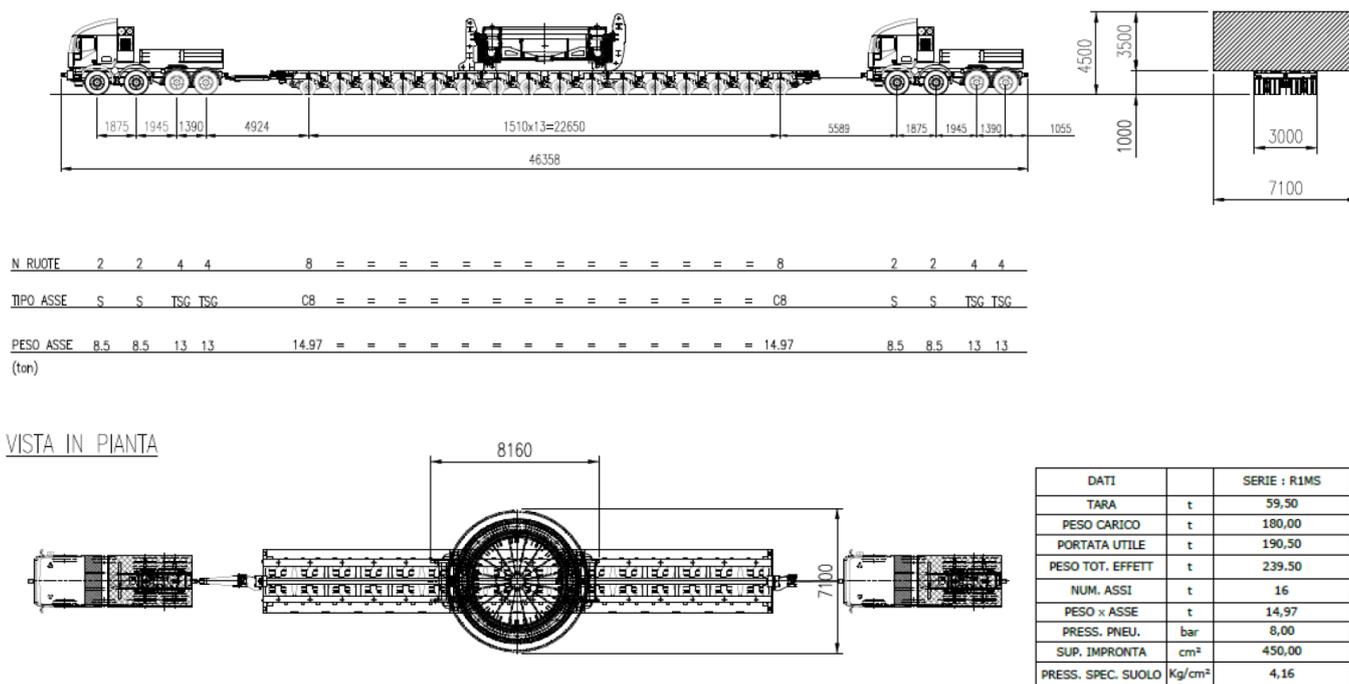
Viste in sezione e planimetria della macchina che trasporta la TBM
